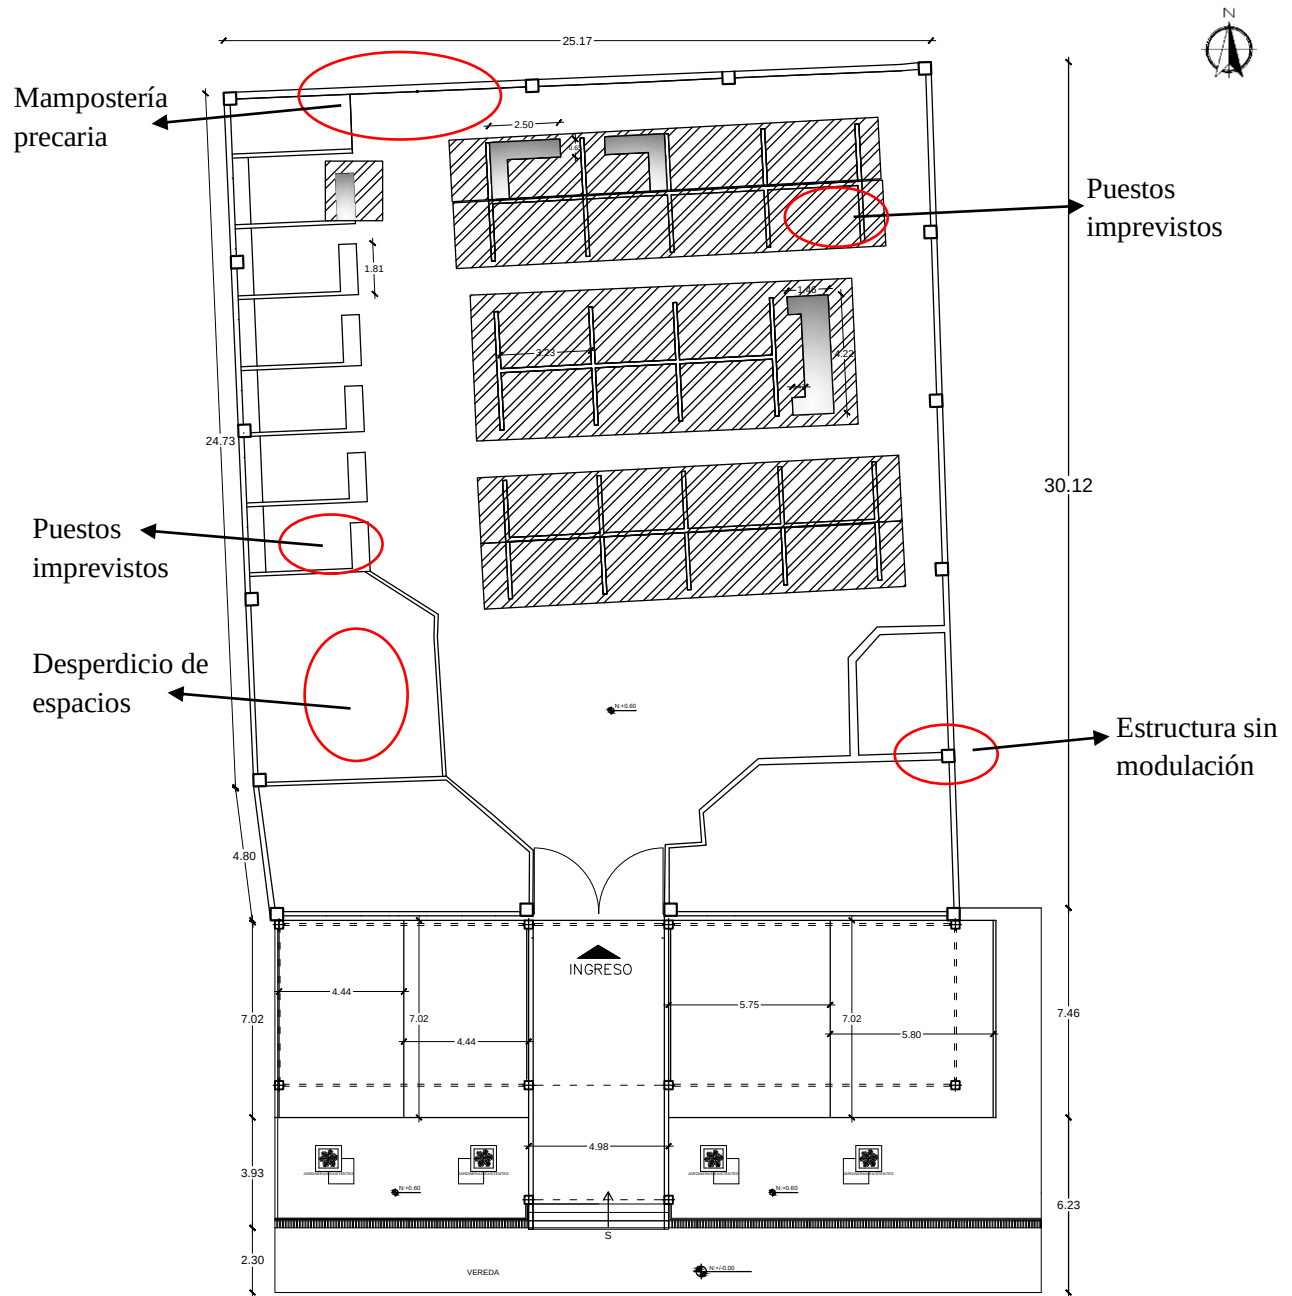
Planta arquitectónica N+0.80 del mercado “El Dorado”
